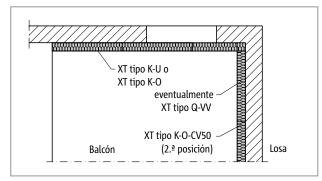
Schöck Isokorb® XT tipo K-U/K-O, XT tipo Q-VV: Balcón en esquina interna, apoyado sobre dos laterales
